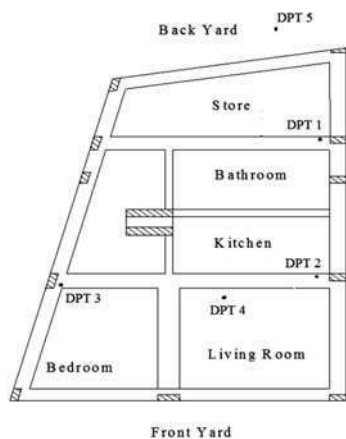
VISTA IN PIANTE DELL'EDIFICIO CON I PUNTI D'APPLICAZIONE DELLE PROVE DPT (CASO 1)
